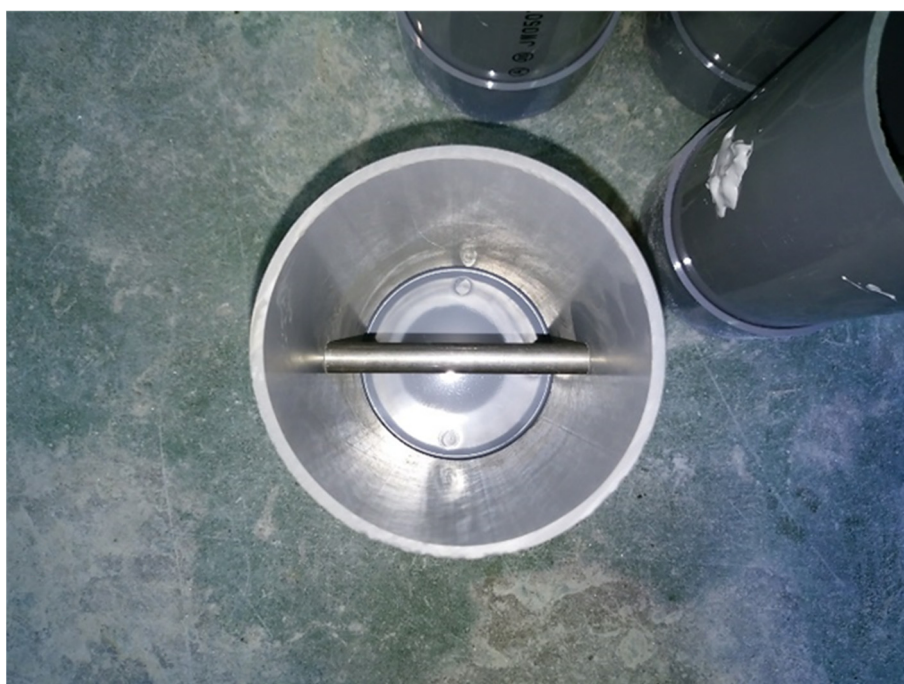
予めひび割れを入れたコンクリート供試体の型枠
